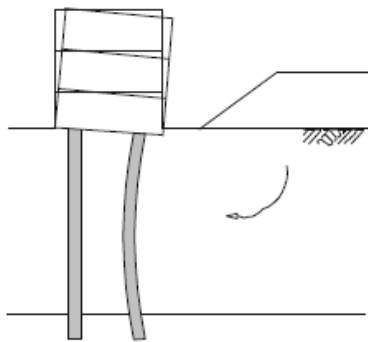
Exemplo rotura da estrutura da estaca por encurvadura (Santos, Fundações por Estacas - Ações Verticais, 2008)
